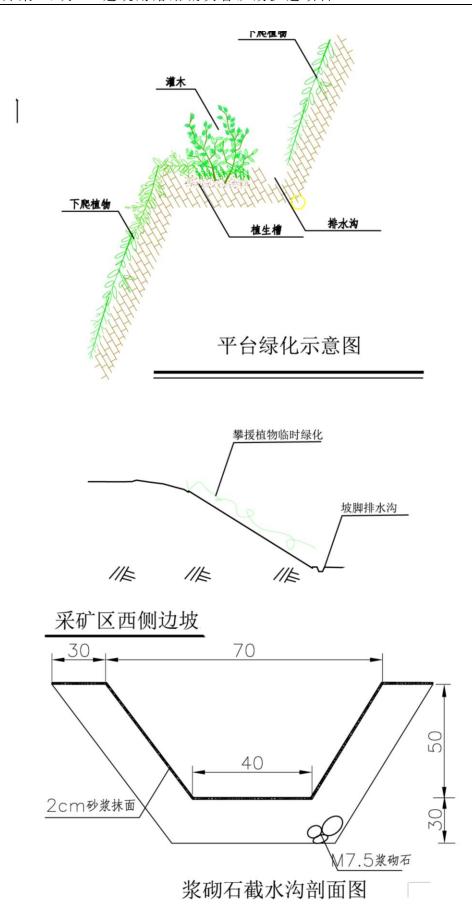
采矿区典型生态保护措施平面布置示意图
